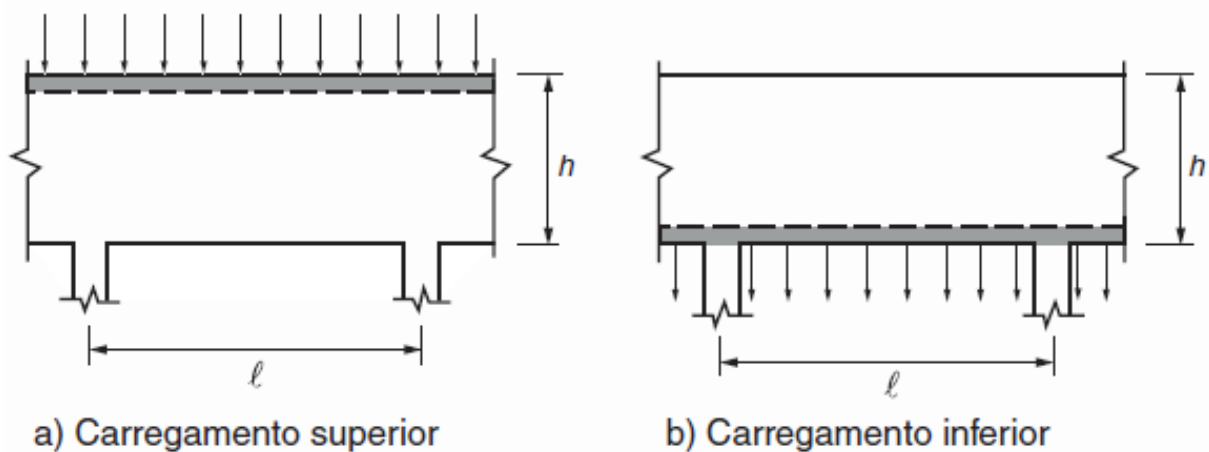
7 - Dois tipos comuns de carregamento em vigas-parede (NBR 6118:2014).
